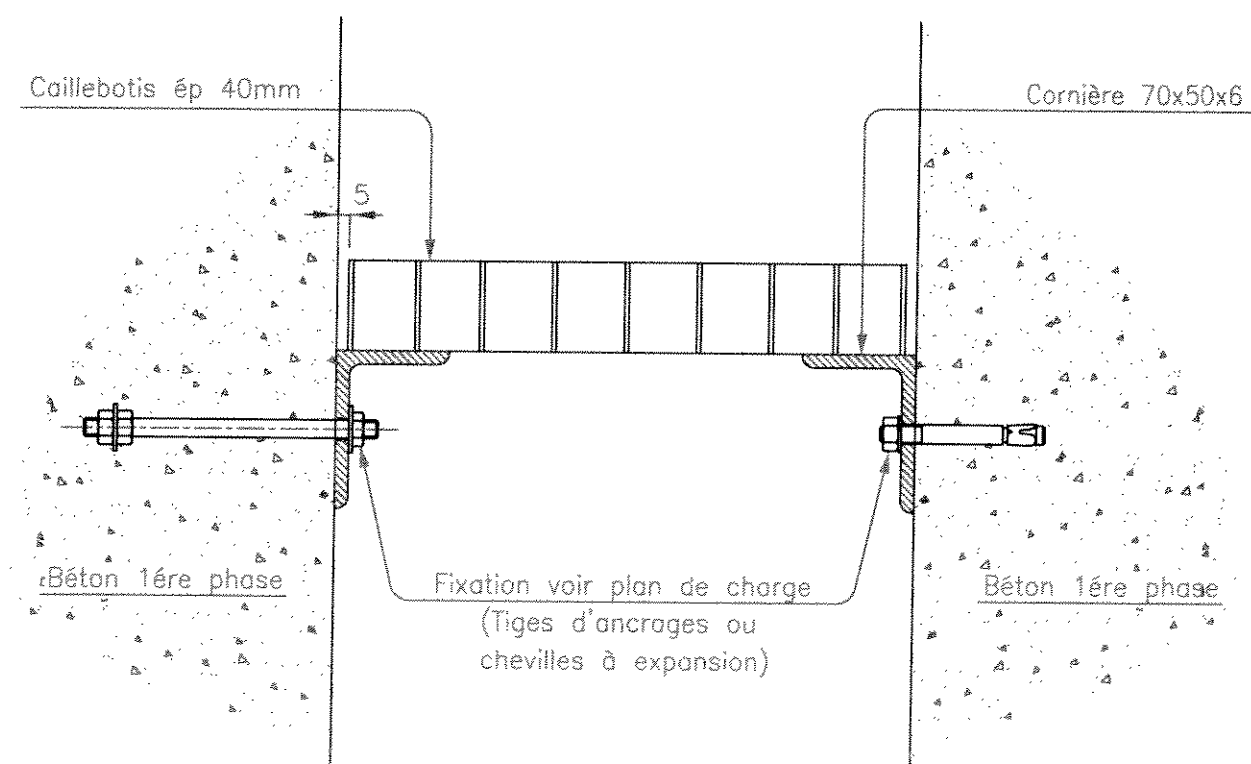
PLATELAGE — BORDURE EN CONSOLE SUR VOILE BETON
